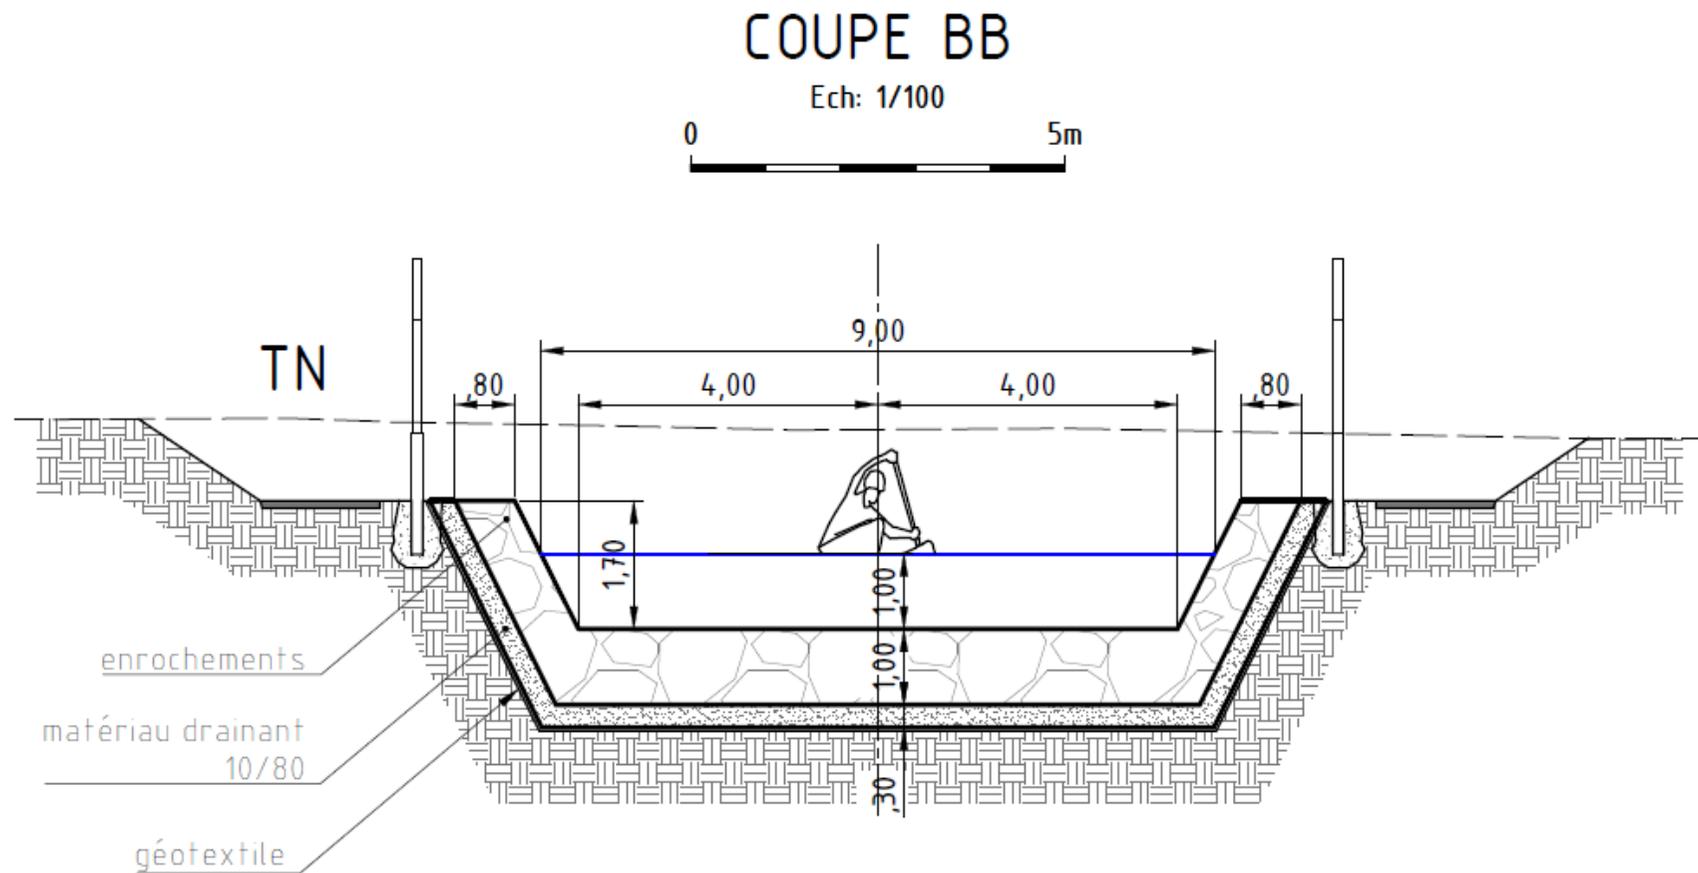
Coupe type sur une section en béton armé au niveau d'une vasque
